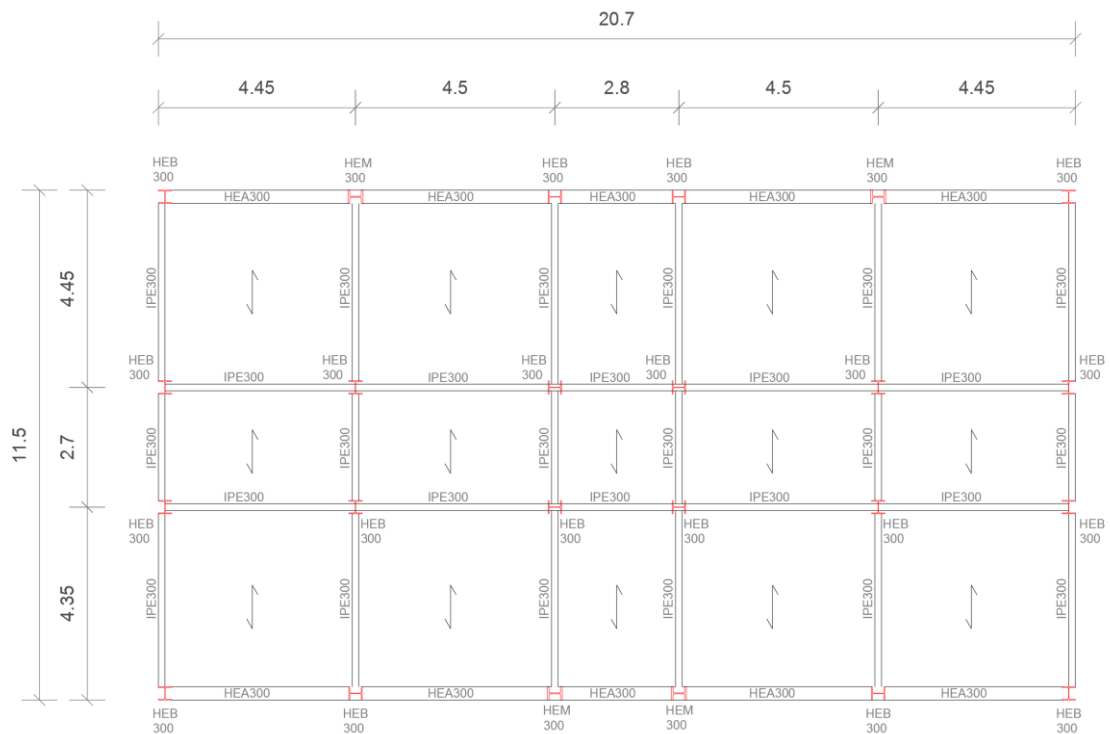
Carpenteria solaio di sottotetto struttura in acciaio a due piani.
